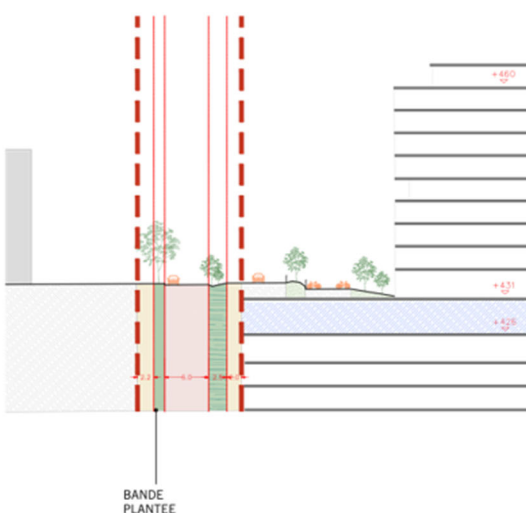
Coupes et élévations sur la façade ouest : façade d'accueil des flux motorisés
